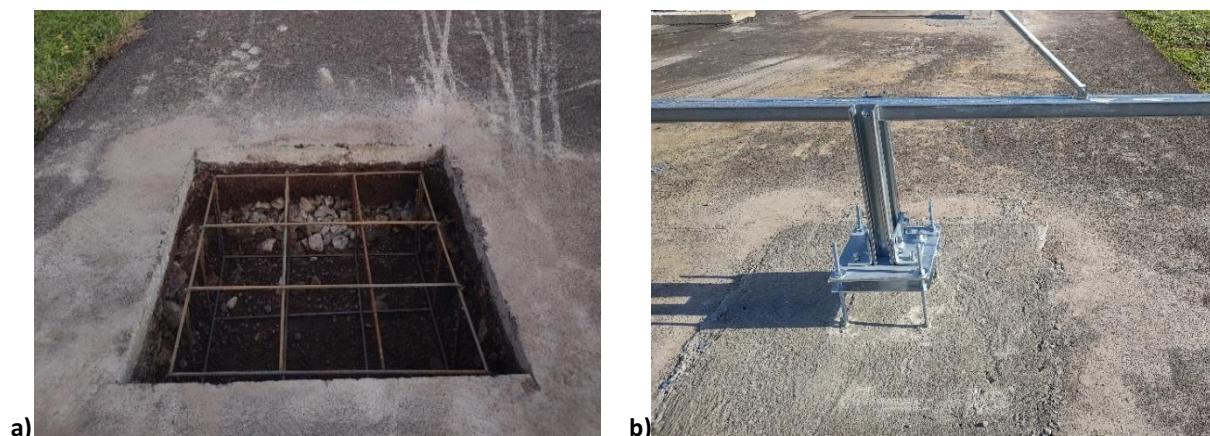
a) Particolare di uno scavo; b) Particolare di una fondazione.
